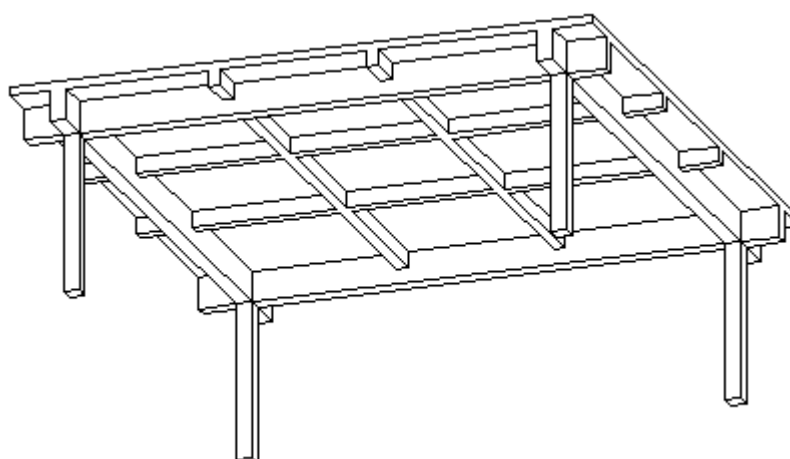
Perspectiva de um pavimento com lajes mistas steel deck
